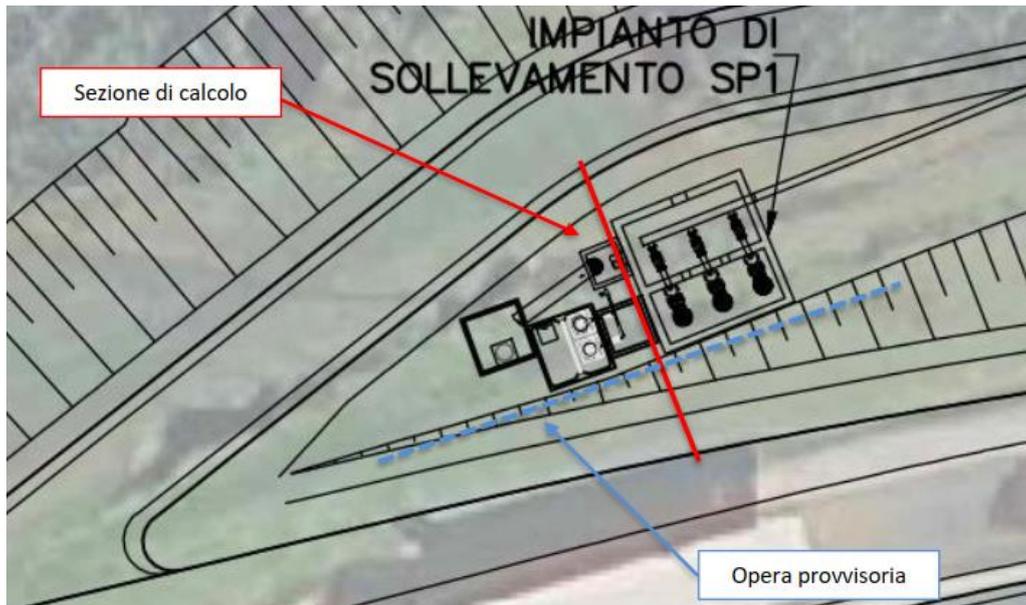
Planimetria opere provvisorie per sostegno degli scavi per la posa dell'impianto di sollevamento situato circa alla progressiva km. 0+060,00
